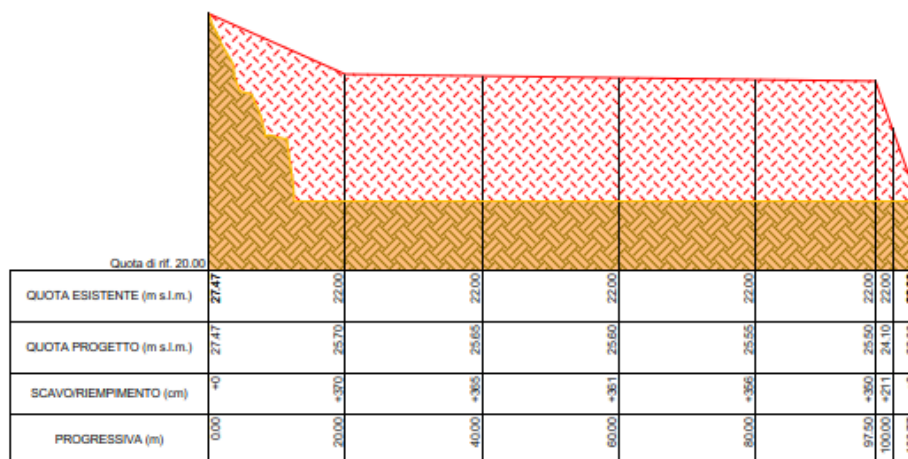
Profilo longitudinale di progetto della scogliera. Estratto della tavola PF.0.2.7.PR.GE.S.Z.0.0.2.A.
